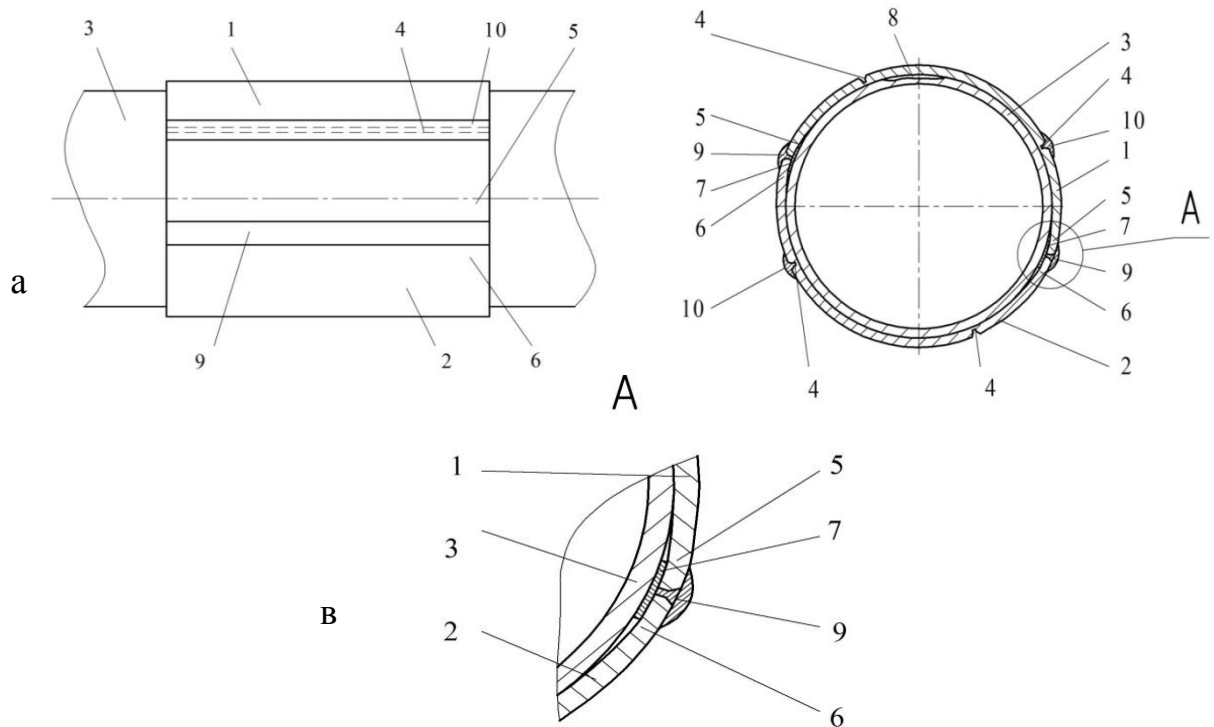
Конструкция разработанной муфты для ремонта трубопроводов: а - вид сбоку двух полумуфт, б - фрагмент поперечного сечения отремонтированной трубы с установленными полумуфтами, в - фрагмент узла стыковки полумуфт
